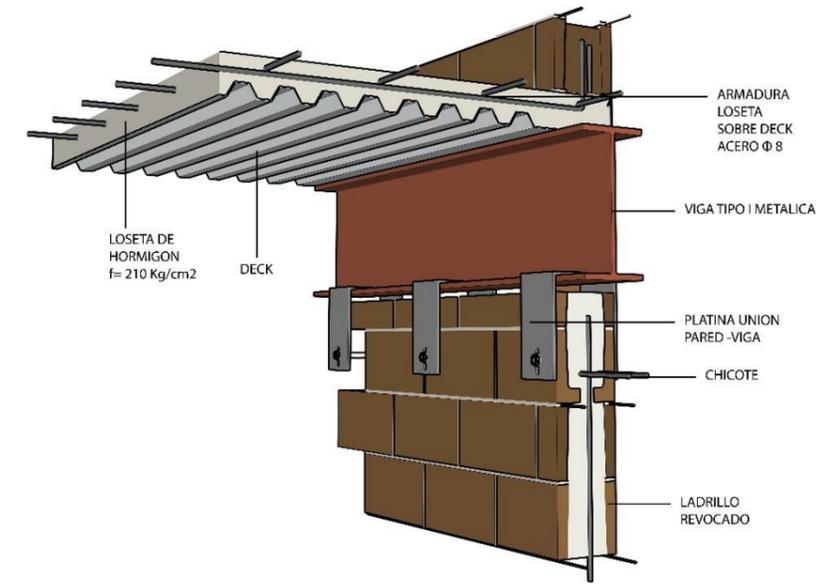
Detalles de unión de pared viga y loseta de hormigón.
